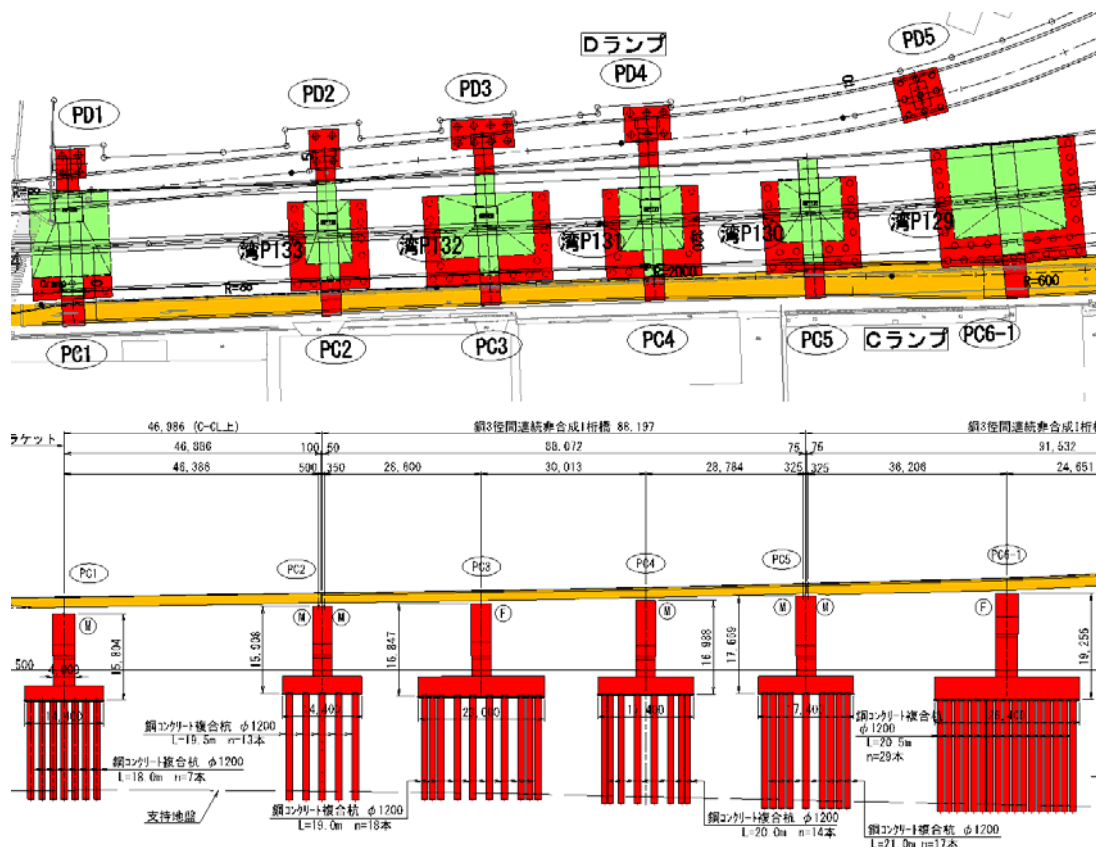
三宝入路（泉佐野方面行き）橋脚平面図・縦断面図
